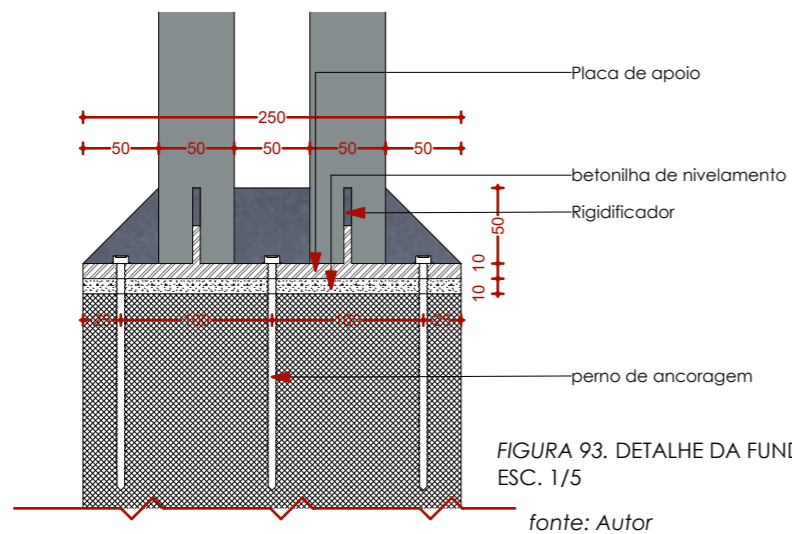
DETALHE DA FUNDAÇÃO DO PERGULADO
